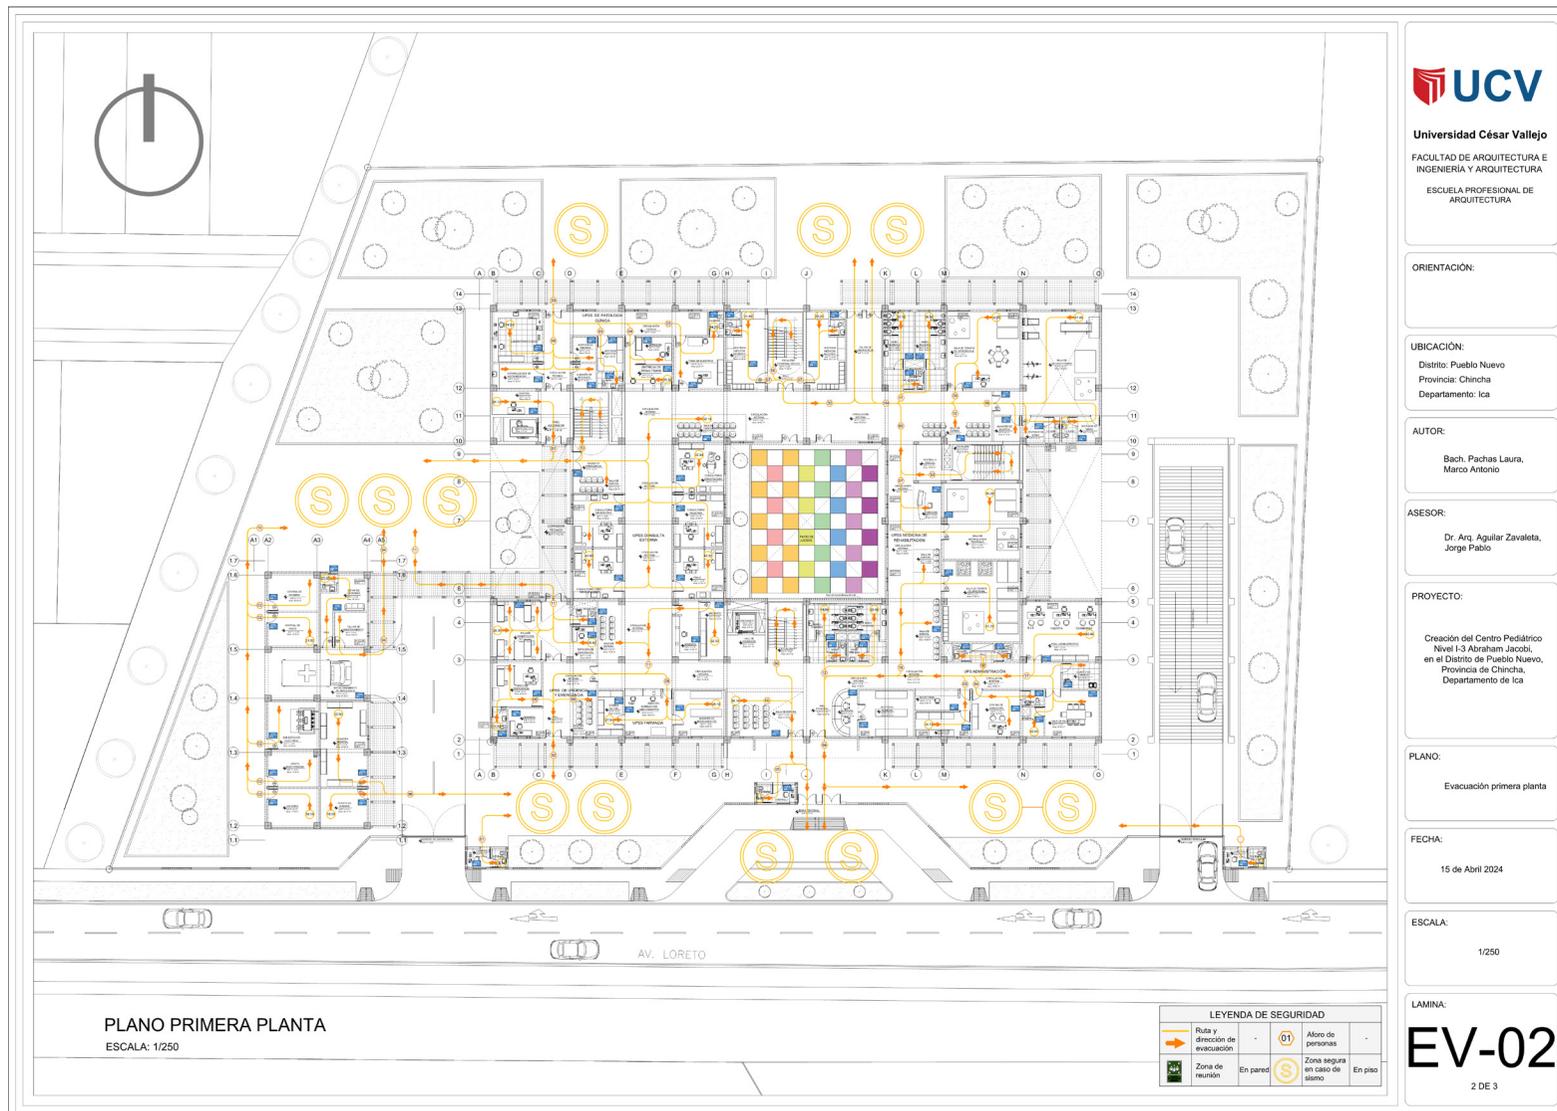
EV-02 Plano de evacuación 1° planta. Fuente: Elaboración propia.
